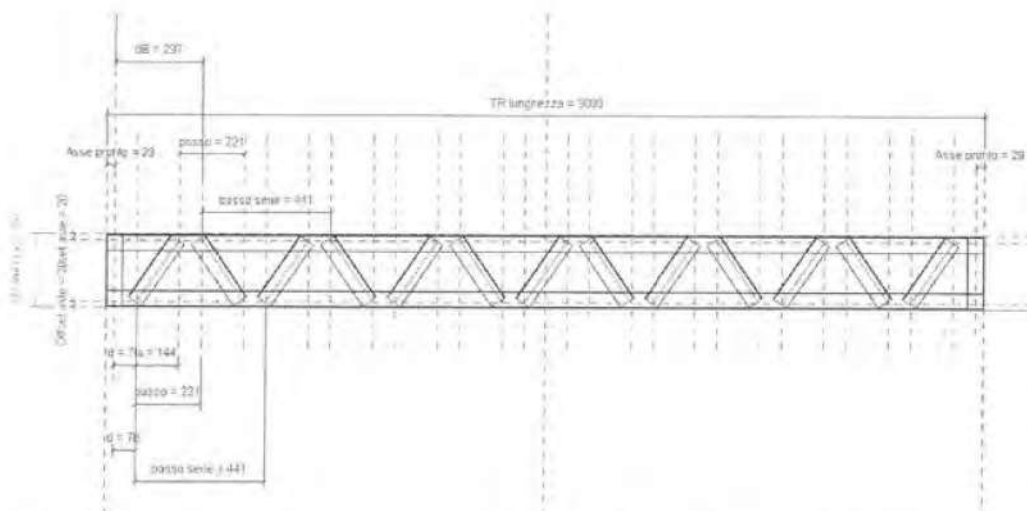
Parametrizzazione geometrica della trave reticolare. Autore Lewis Dal Magro.
